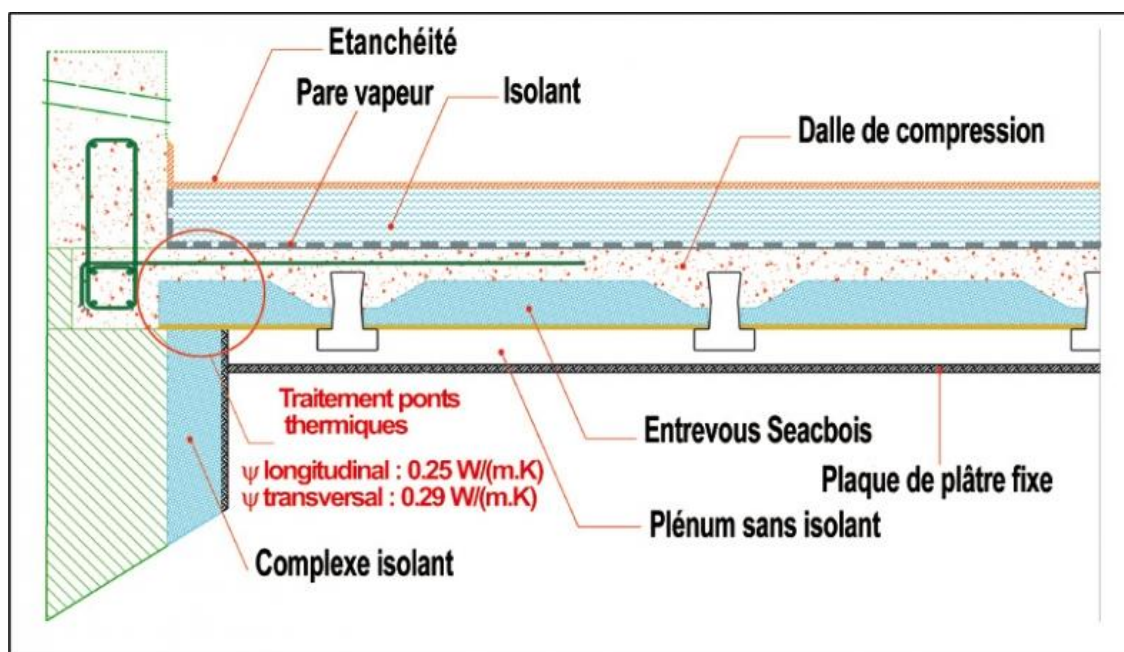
Détail fixation faux plafond. Source <http://kelisol.fr/isolation-du-toit/isoler-toiture-plate/>
